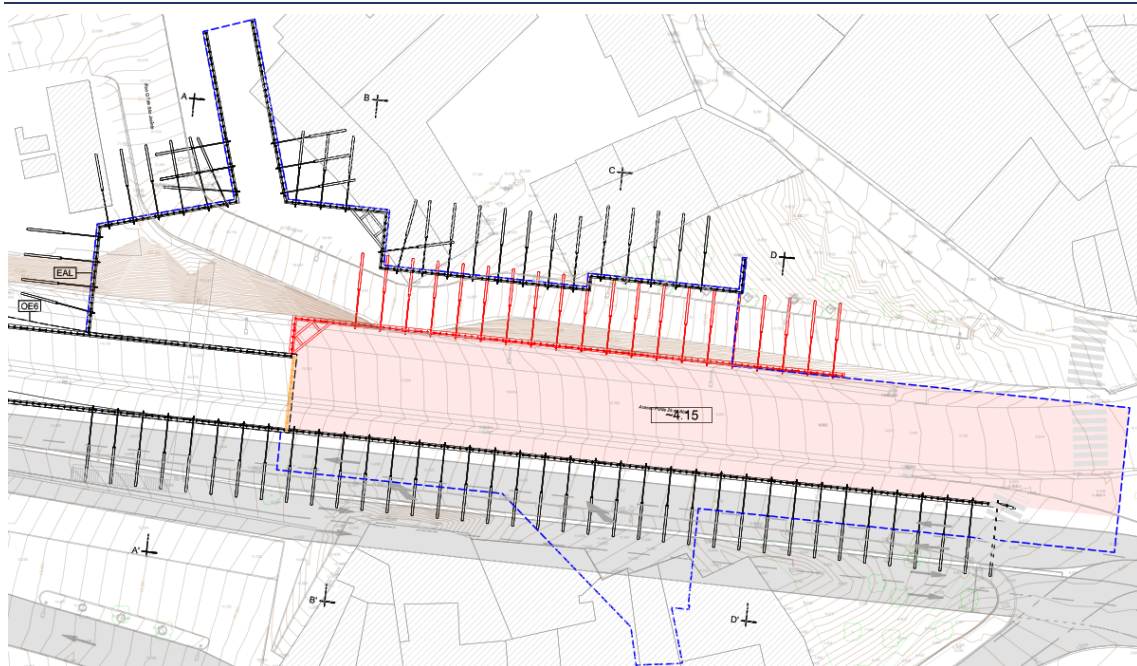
Planta de Dimensionamento Contenção Provisória – 2ª Fase de escavação
